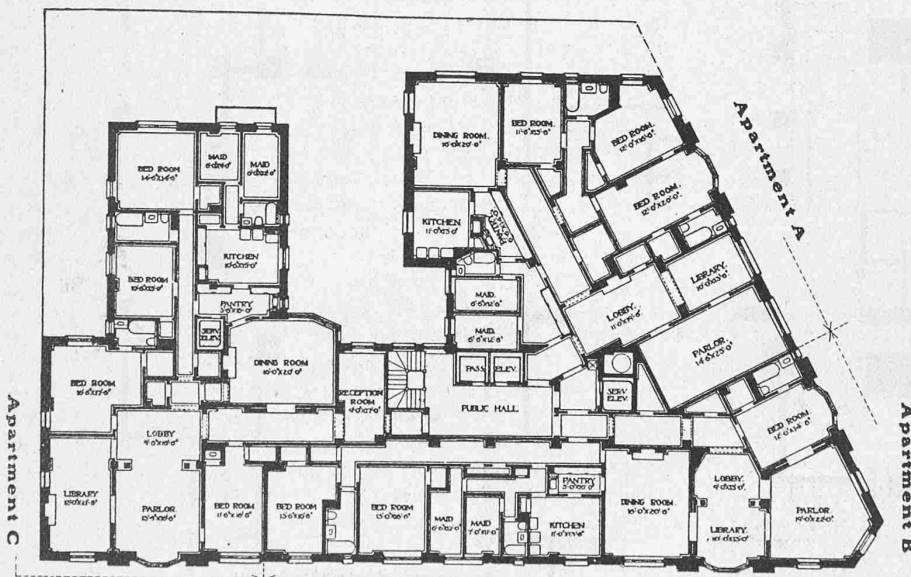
Spencer Arms Appartement-Building, New York. — Grundriss 1 : 400.
